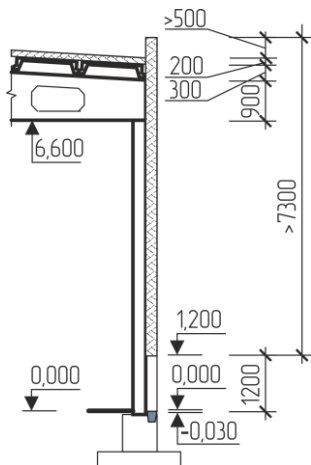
Условная схема расположения наружных стеновых панелей
